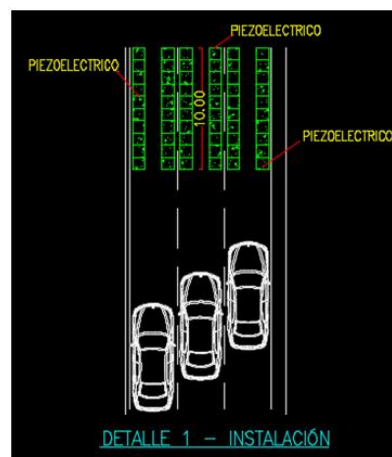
Detalle de instalación Avenida Calle 17 por calzada. (Del autor)
